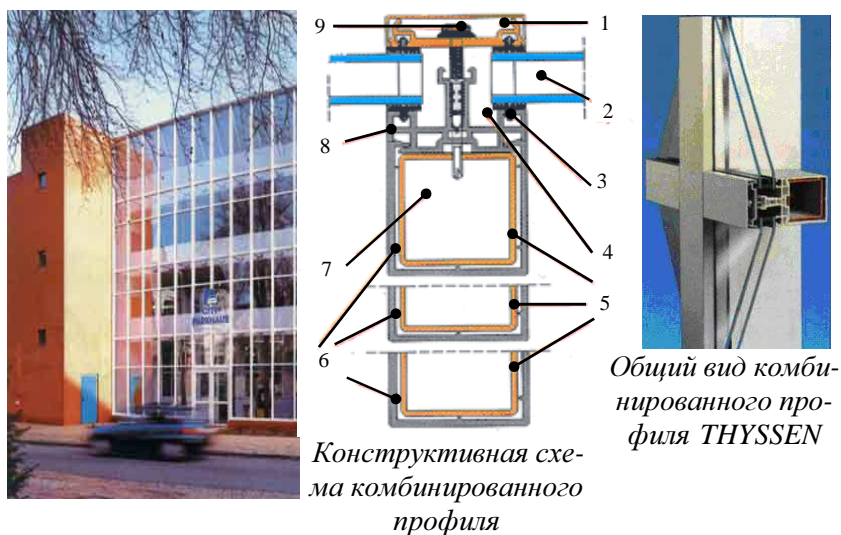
Стекланный фасад из комбинированных профилей фирмы THYSSEN.
